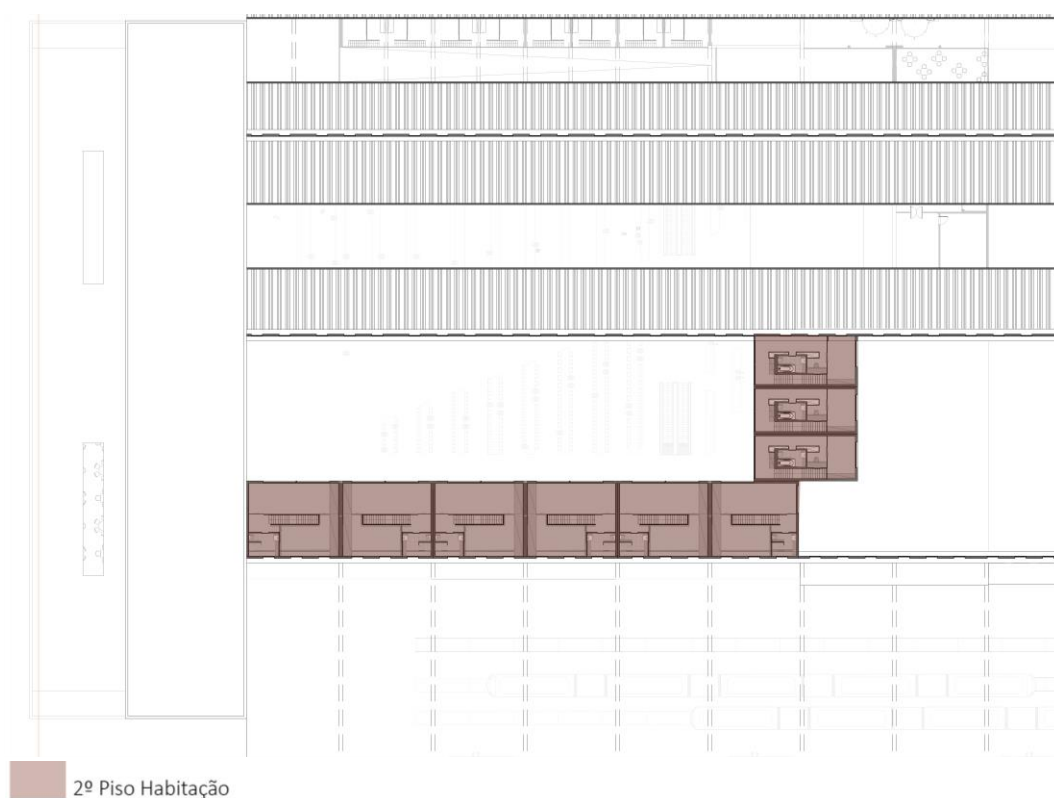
Imagem da Planta Piso 3 – Habitação, Fonte: Realizado pelos autores.
